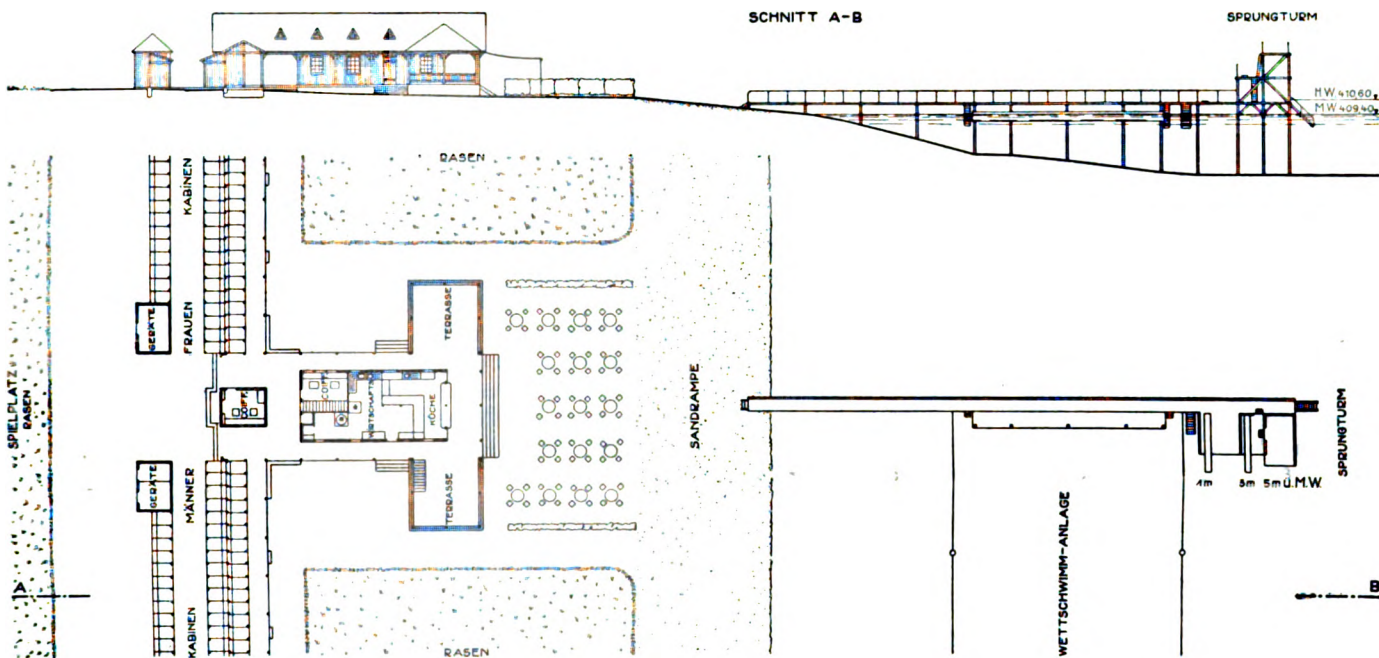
Mittelpartie des erweiterten Zürcher Strandbades. — Grundriss und Schnitt A-B, 1:600.
